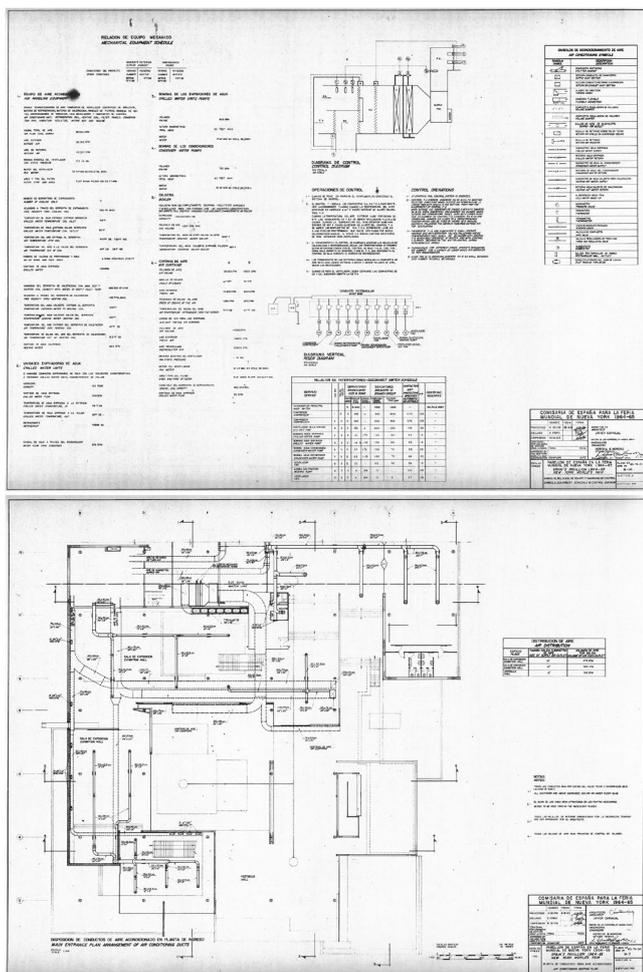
Plano con la relación de equipos mecánicos (arriba) y planta de conductos de planta de ingreso (Archivo Heredia & Moreno, S.A).
